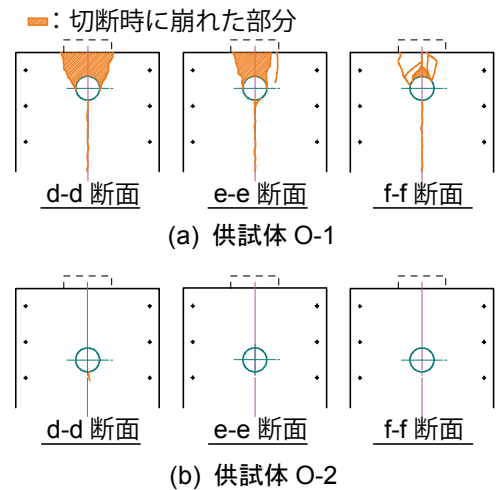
供試体 O-1, 2 内部のひび割れ
